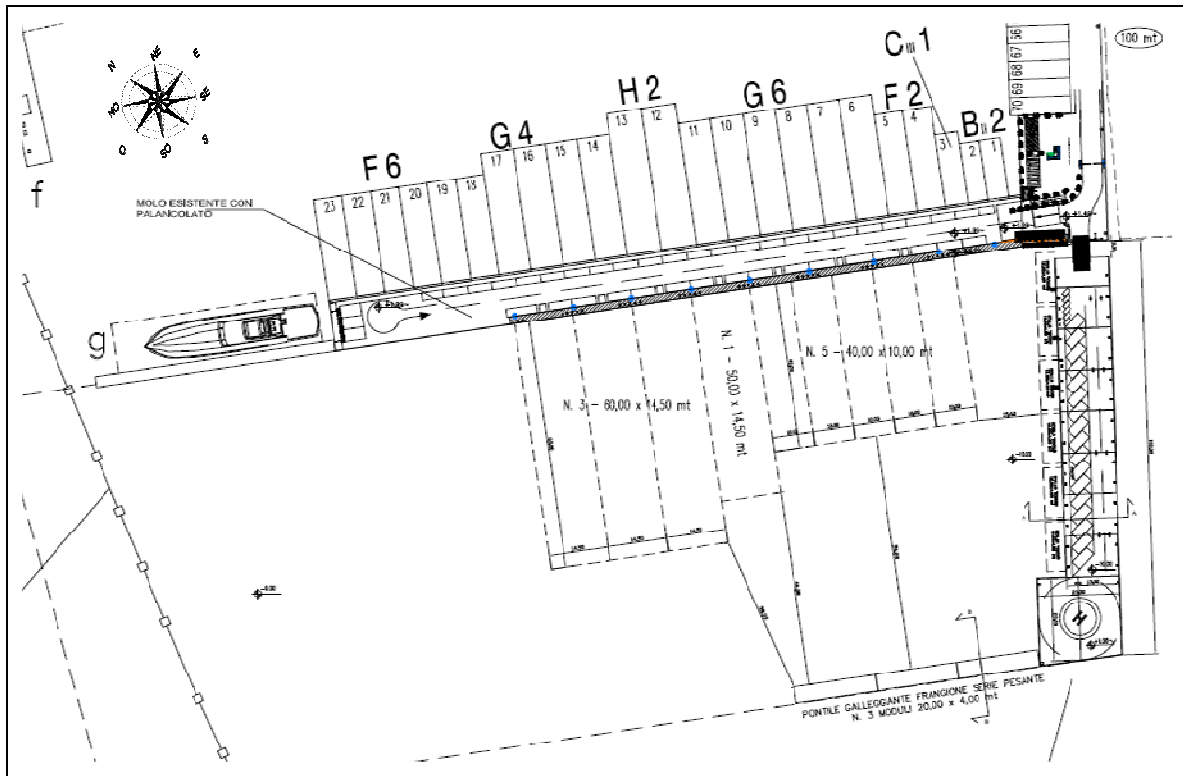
Planimetria di dettaglio intervento – fase 1
